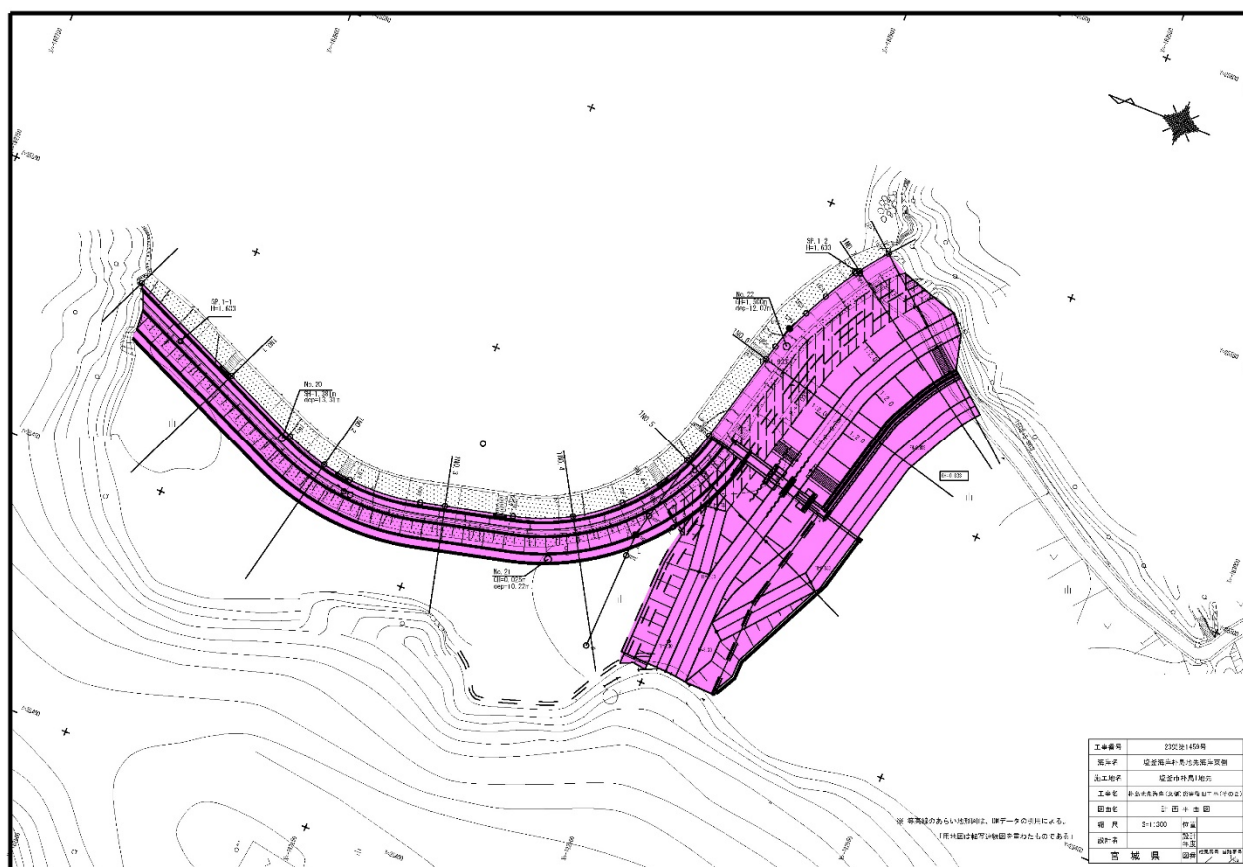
復旧計画平面図【朴島 1 海岸】
